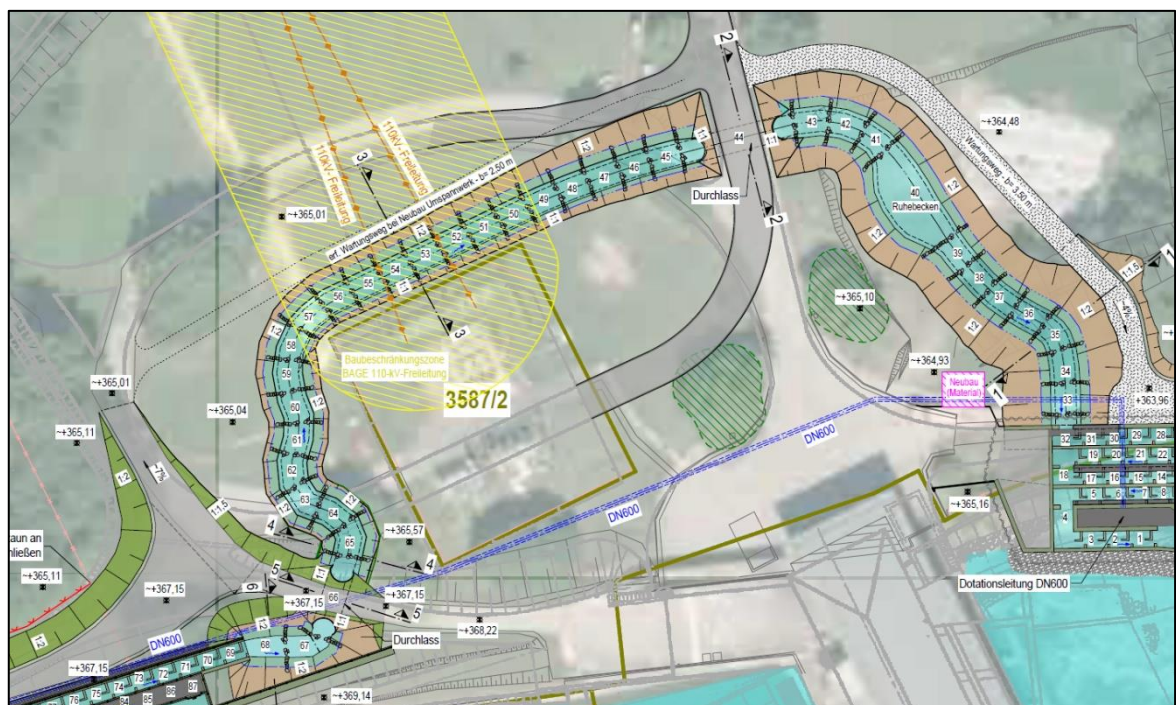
Draufsicht – Raugerinne-Beckenpass
